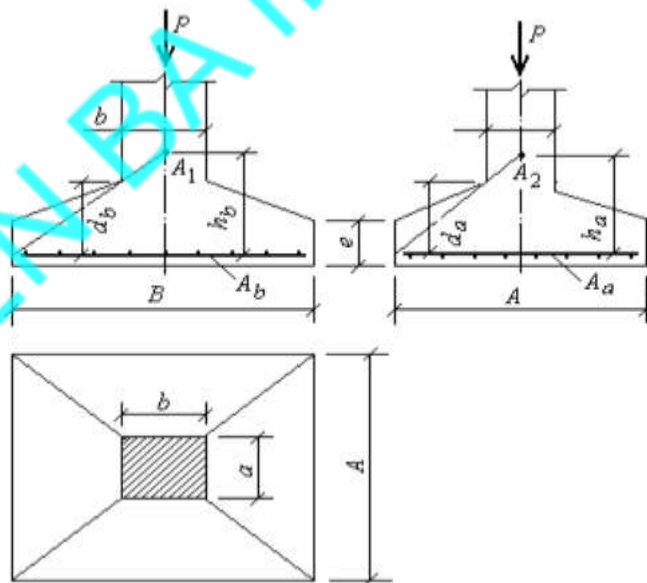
semelles rectangulaires sous poteau rectangulaire soumis à un effort normal centré
